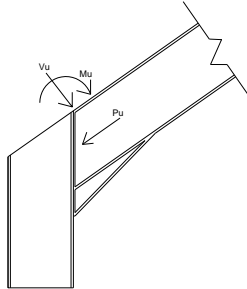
Detail Sambungan Las Geser Lentur
